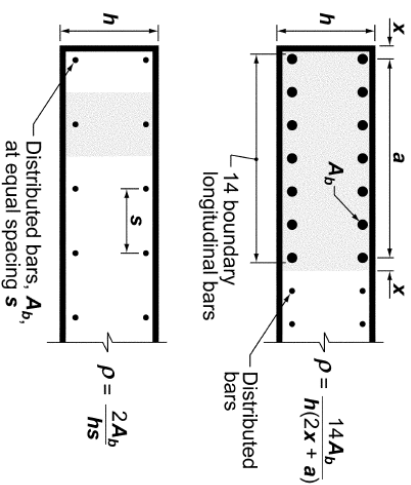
Armatura longitudinale per elementi di confine delle pareti strutturali
